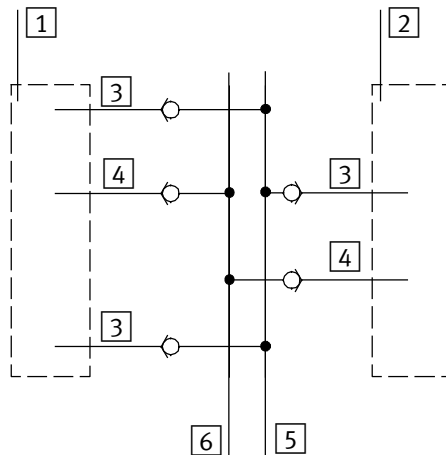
/4: Sammelleitungen mit Rückschlagventilen
